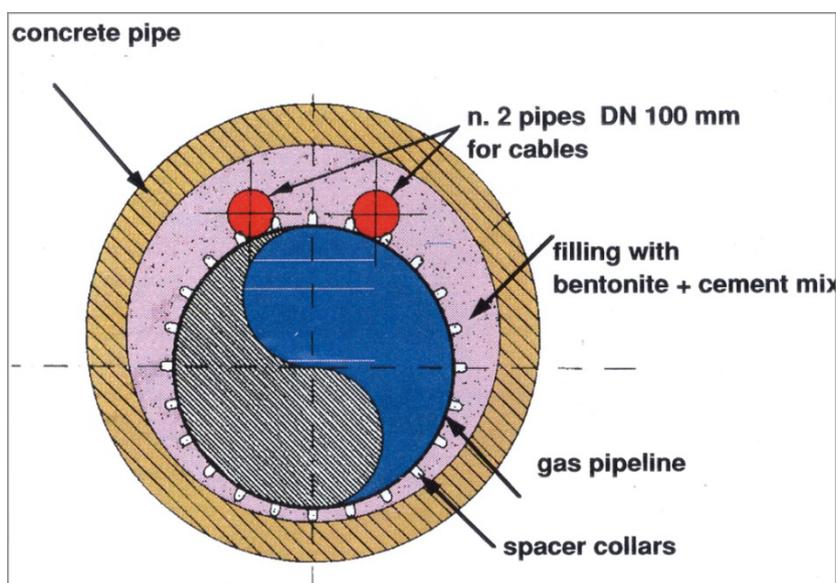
Sezione tipo della condotta posata nel microtunnel al termine dei lavori
